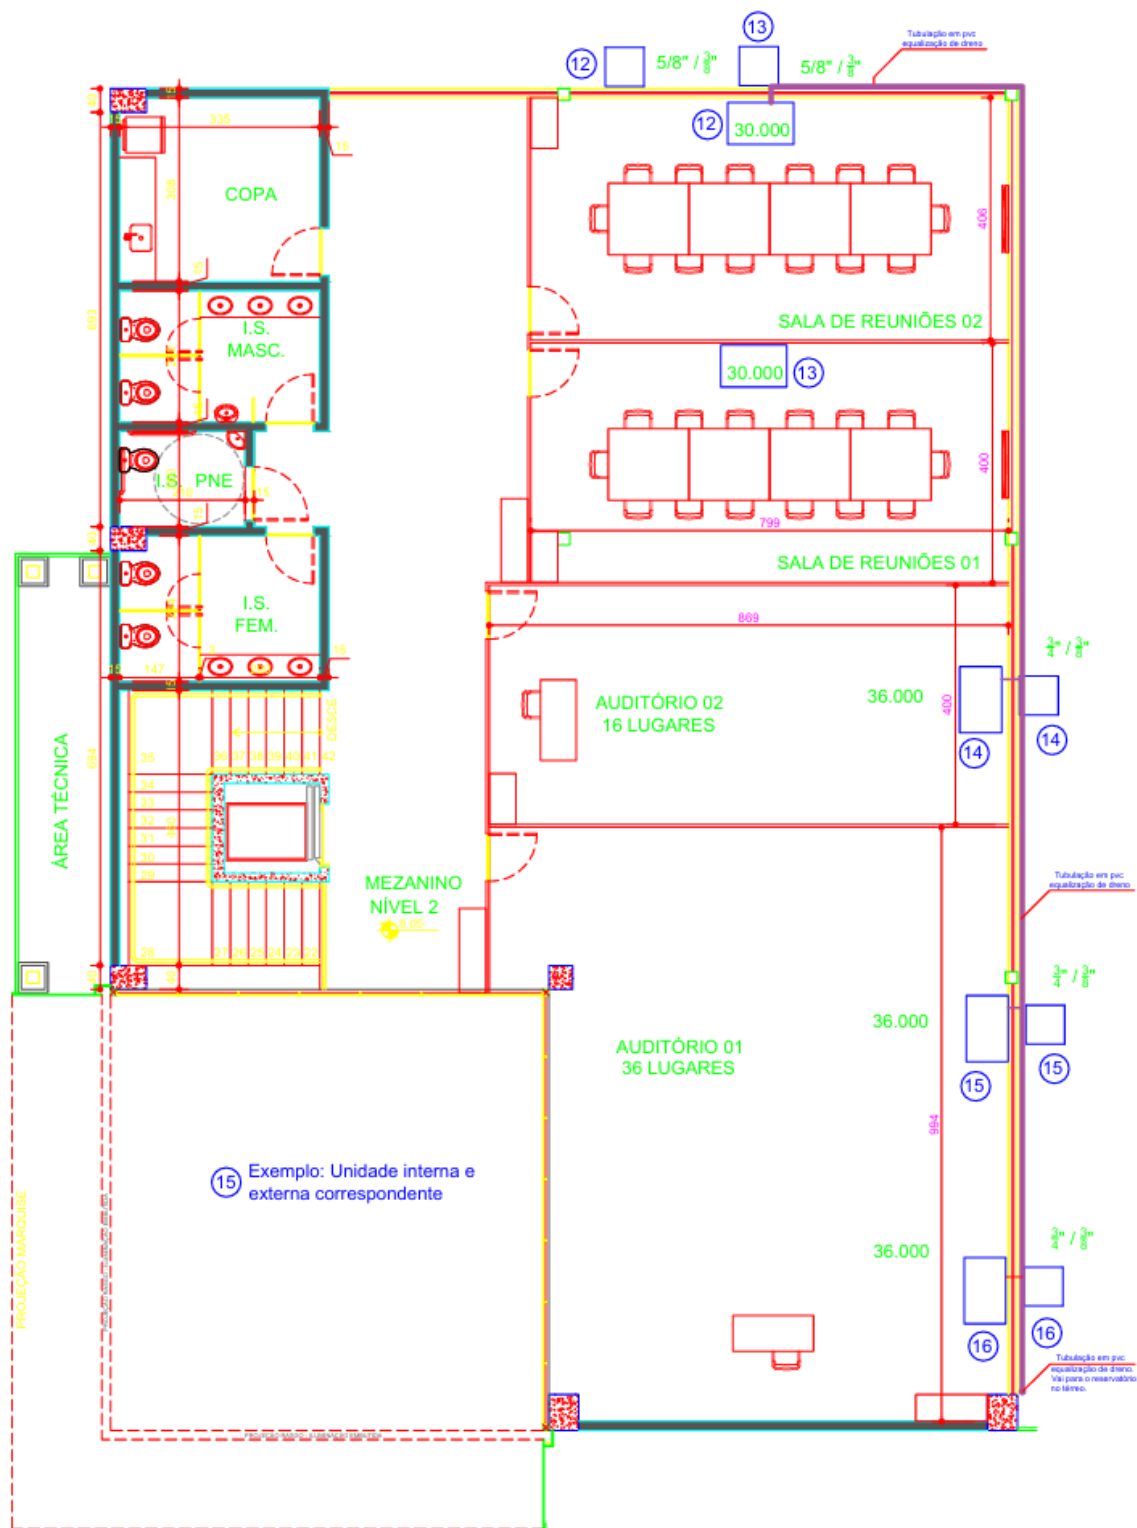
Planta do primeiro pavimento com equipamentos de ar-condicionado instalados
